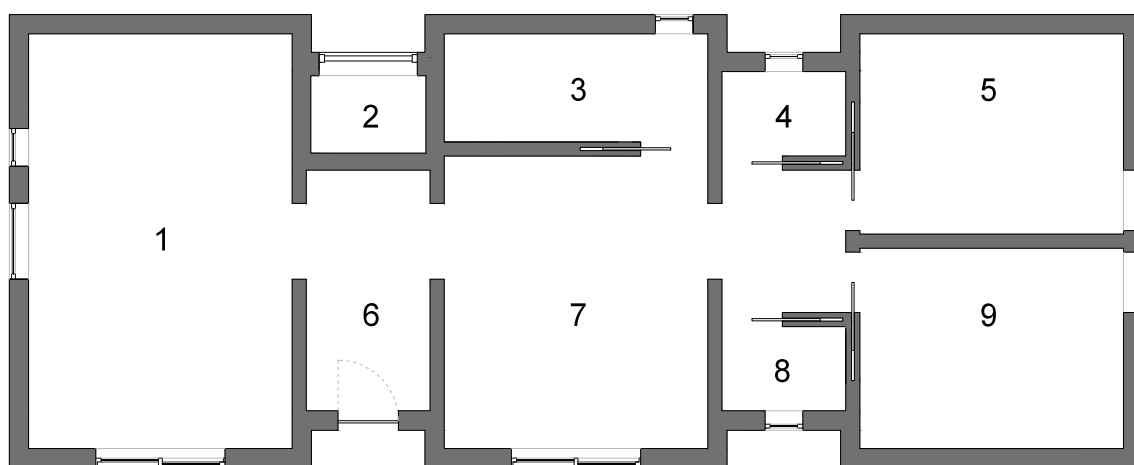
Planta da tipologia T2 (escala 1:100)
